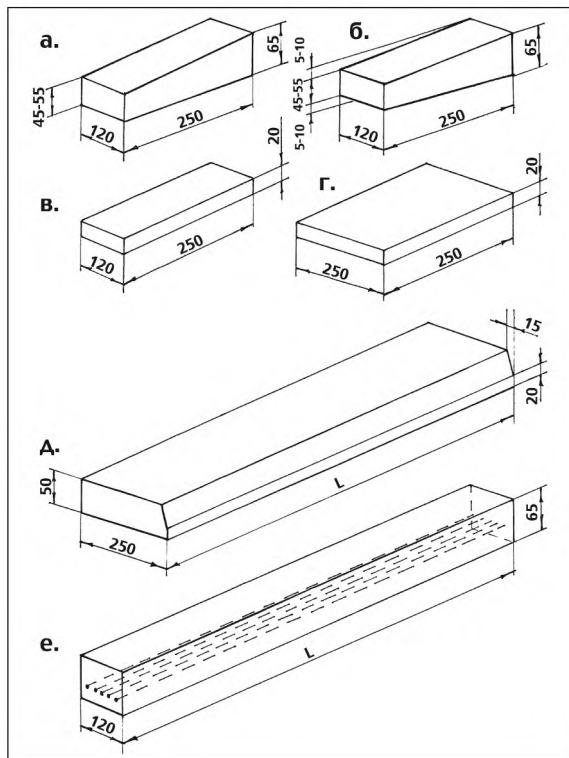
Изделия для перекрытия оконных и дверных проёмов и для отделки стен и подоконников: а., б. Клиновые блоки; в., г. Облицовочная плитка; д. Подоконная плита; е. Железобетонная перемычка.
